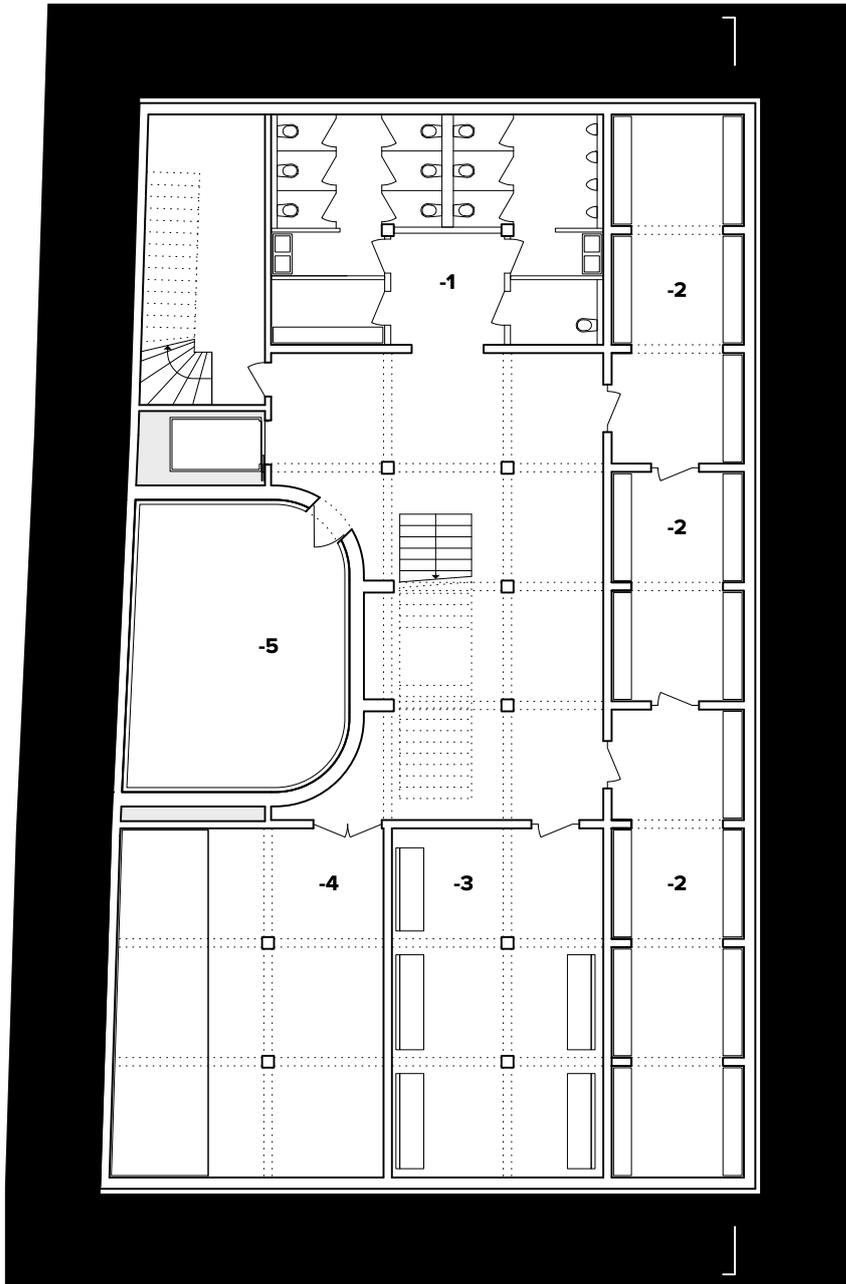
Grundriss Untergeschoss 1.200 (BM)
